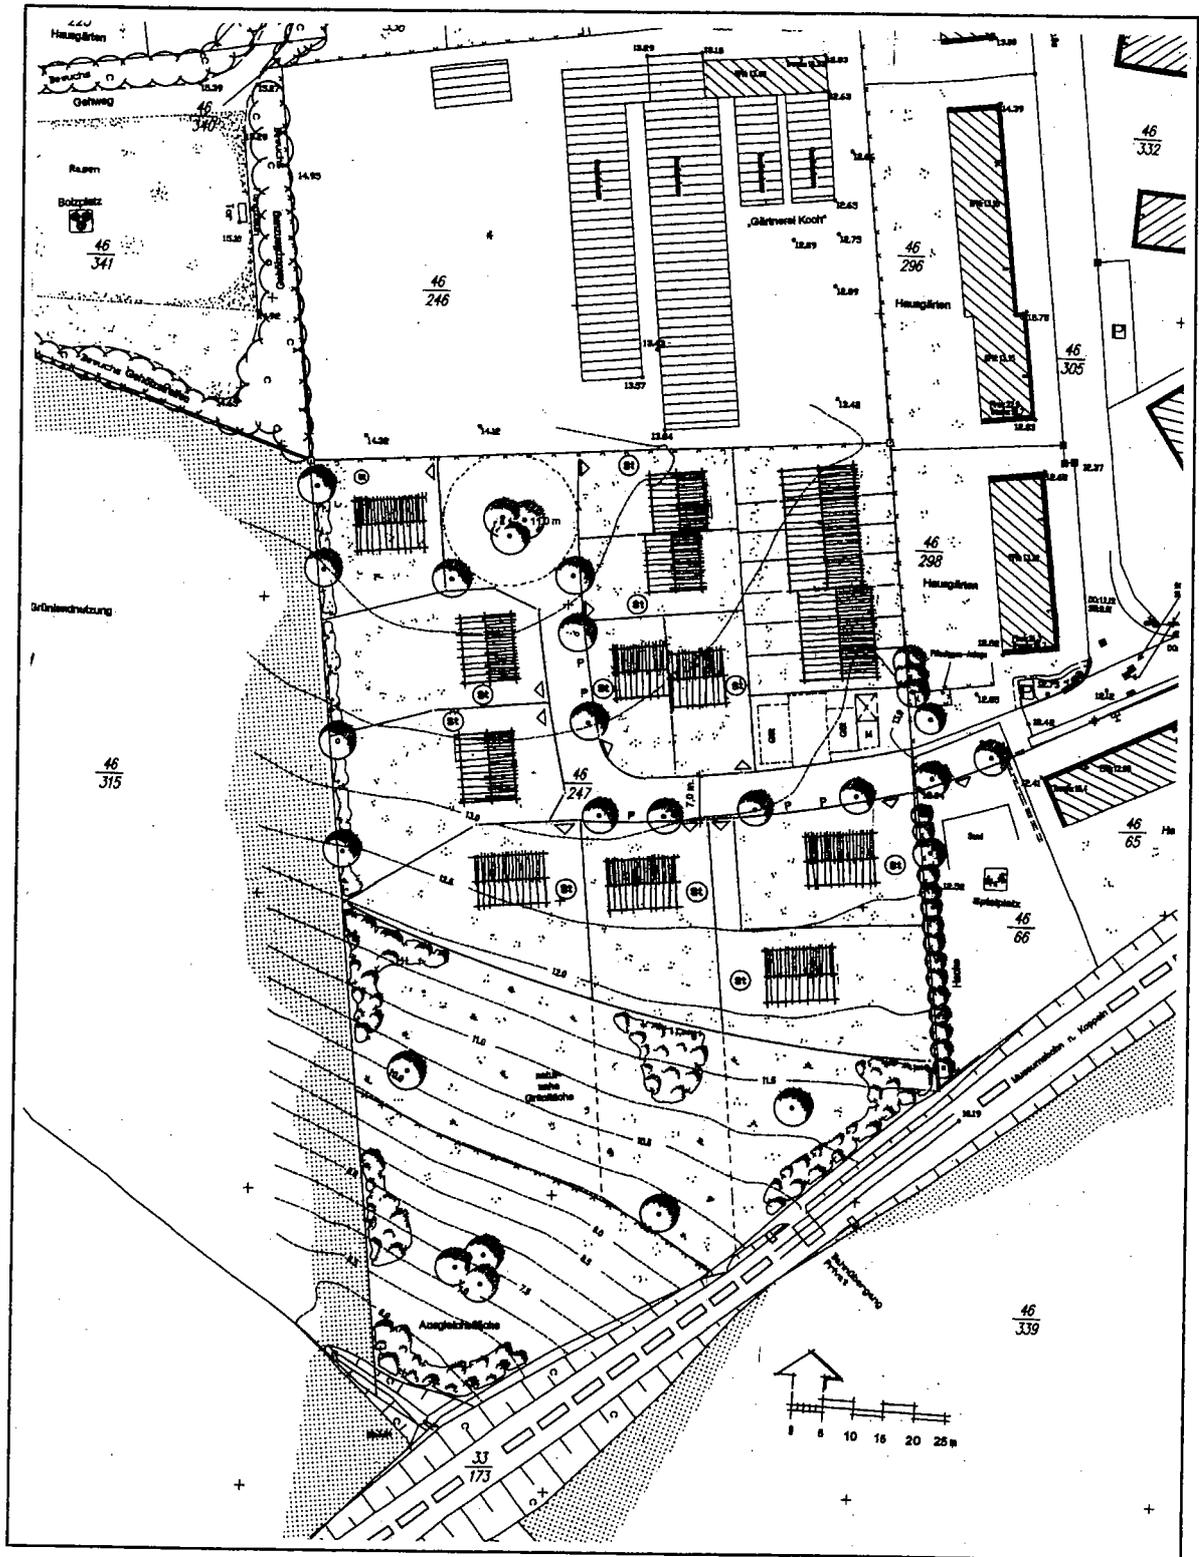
Planausschnitt aus „Städtebauliches Konzept“ zum Bebauungsplan Nr. 45 vom 02.06.2000, ergänzt am 06.06.2000, unmaßstäblich
